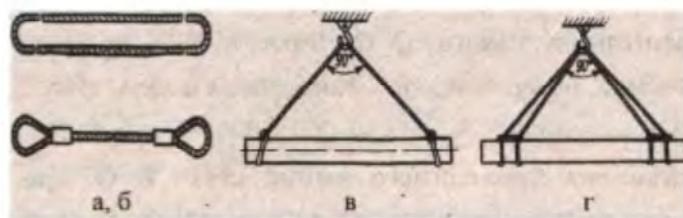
Стропы и схемы строповки: а — кольцевой СКК, б — двухпетлевой СКП, в — схема строповки двумя стропами СКП,
